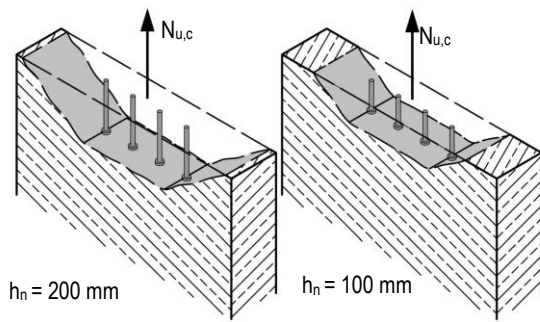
Ausbruchflächen bei Betonausbruch für unterschiedliche Verankerungslängen
